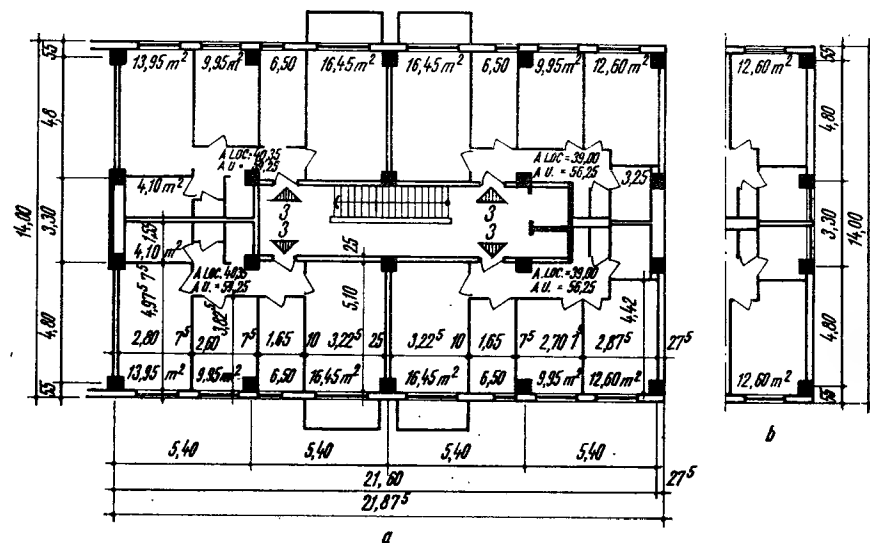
Plan etaj curent pentru o construcție de locuințe, P + 10E, cu patru apartamente la scară, cu structura de rezistență din cadre de beton armat și planșee prefabricate:
